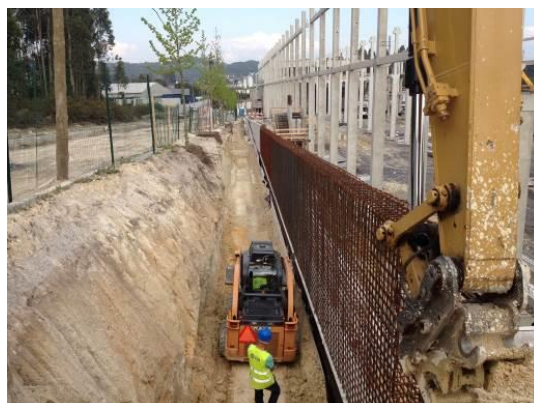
Colocação de muretes em betão armado pré-fabricados (14-04-2015)
